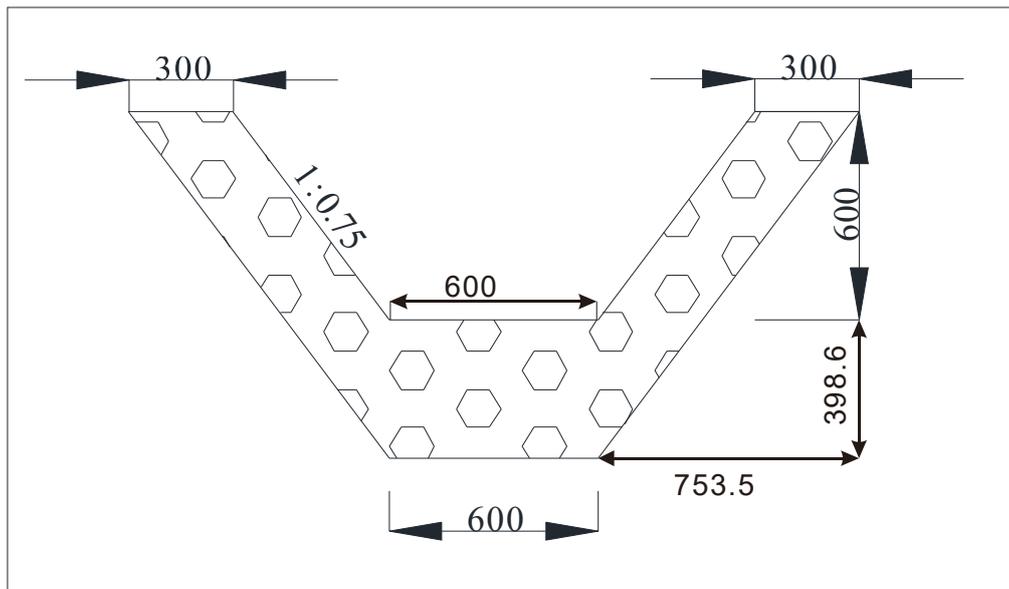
浆砌石排水沟设计示意图 (mm)
